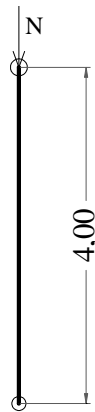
Esquema de Cálculo de las Columnas de tanque de Reserva.
